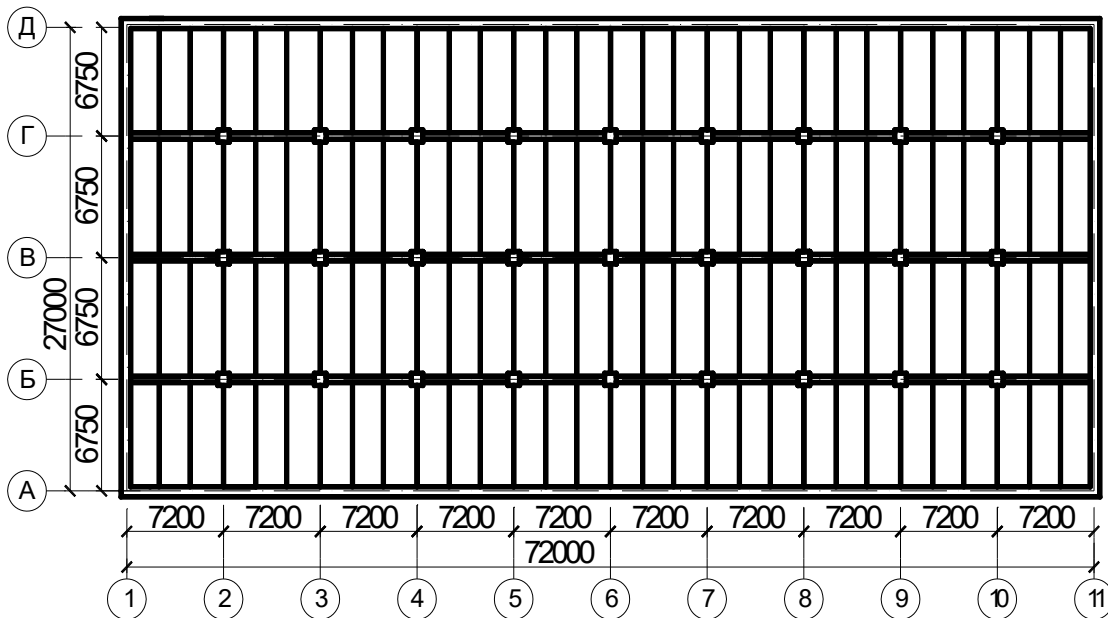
Схема монолитного междуэтажного перекрытия (вариант 2)
